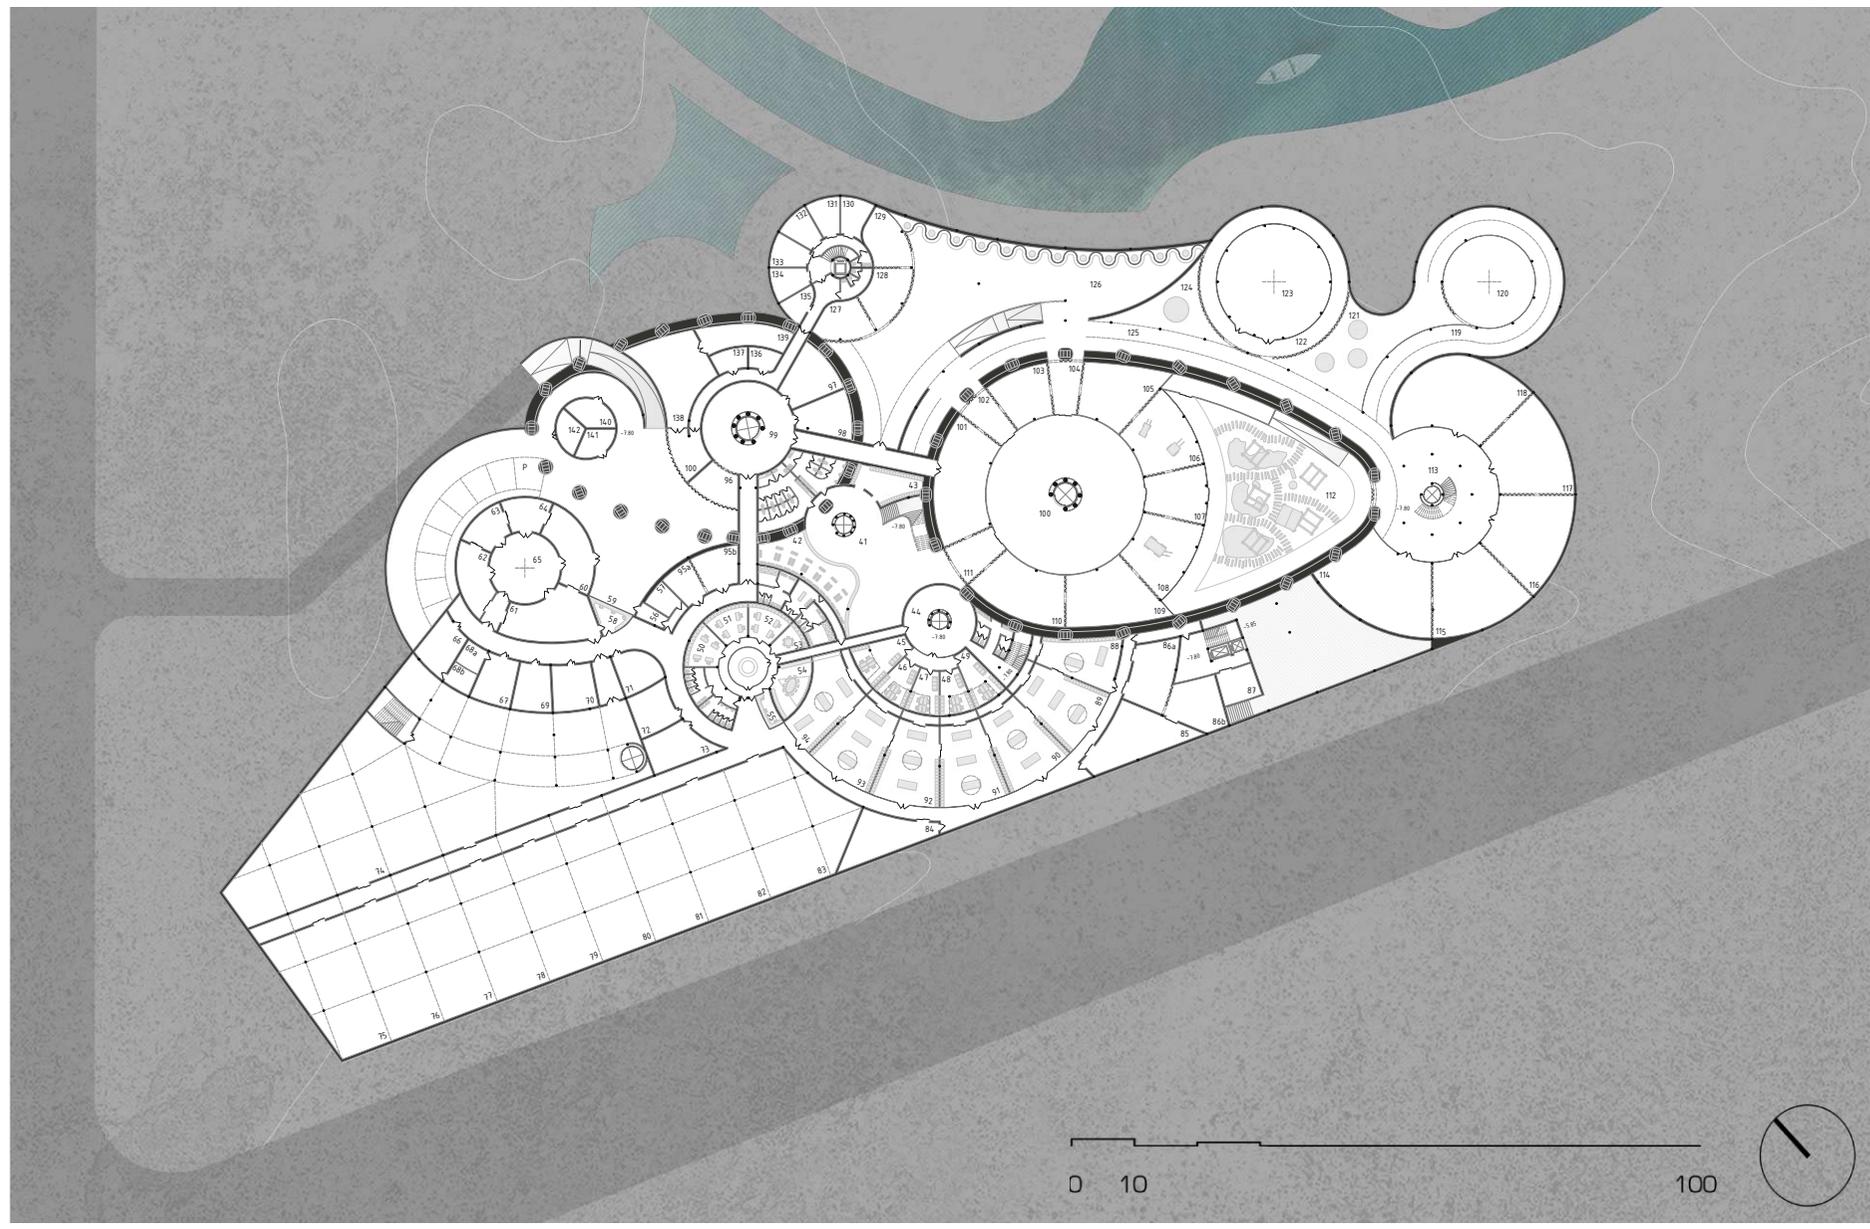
Grundriss. KG, Niveau -7,80
